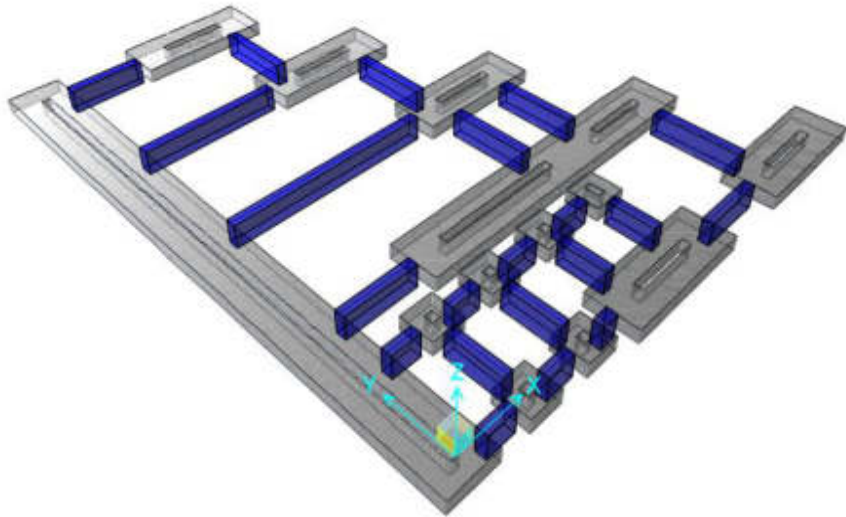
Zapatas conectadas con vigas de cimentación - Vista en 3D
